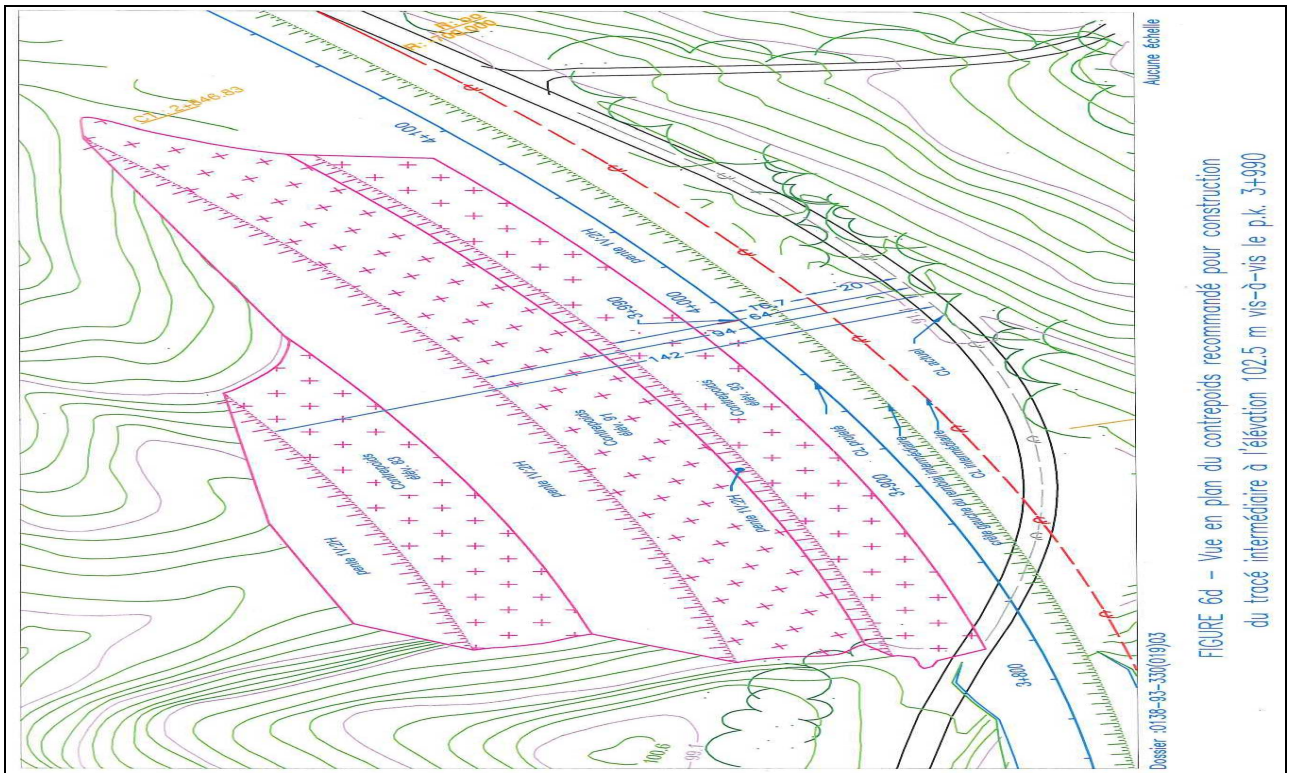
Vue en plan du contrepoids recommandé pour construction du tracé intermédiaire à l'élévation 102.5 m vis-à-vis le p.k. 3+990
